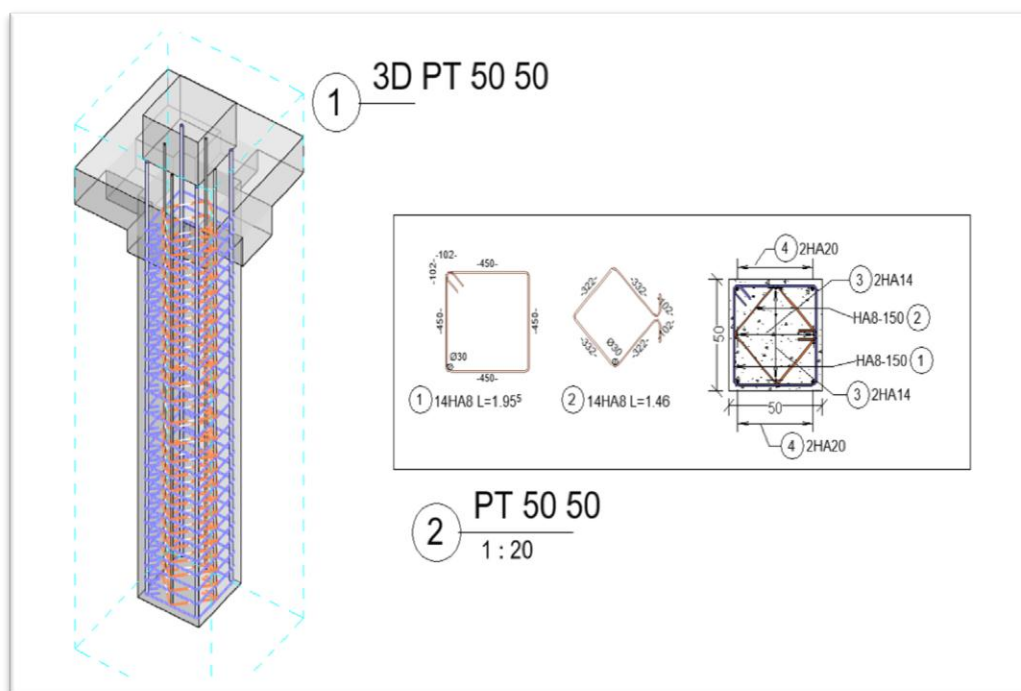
Schéma de ferrailage de poteaux (50*50)
